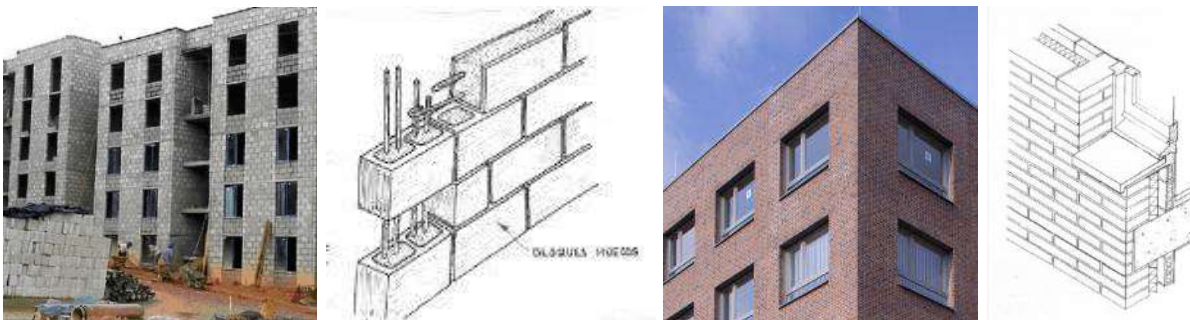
Esquemas Constructivos de fachadas convencionales. - Imágenes de internet
